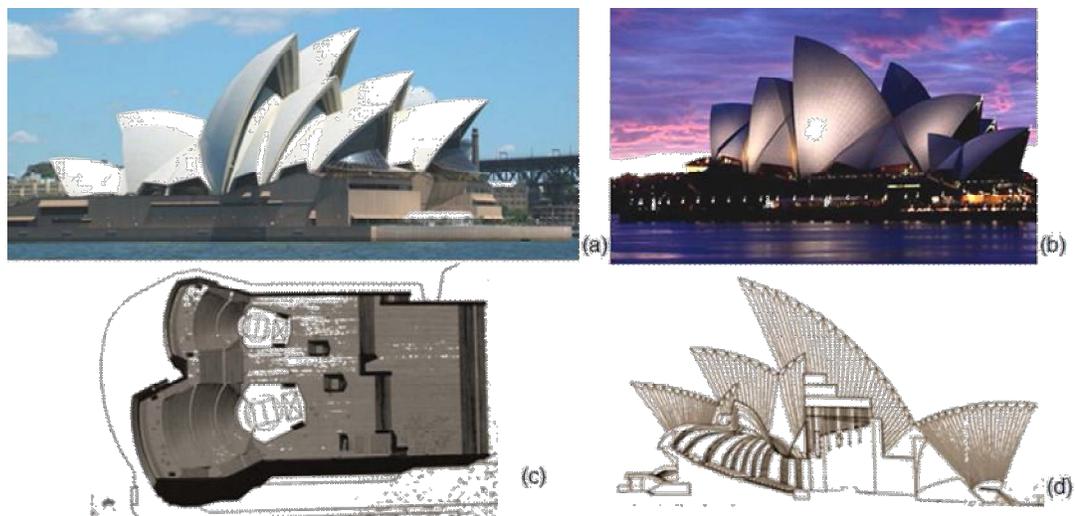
Jørn Utzon, Opera de Sydney, Australia, (1957-1966): (a) Vista exterior de día, (b) Vista exterior de noche, (c) Planta arquitectónica, (d) Sección longitudinal.
